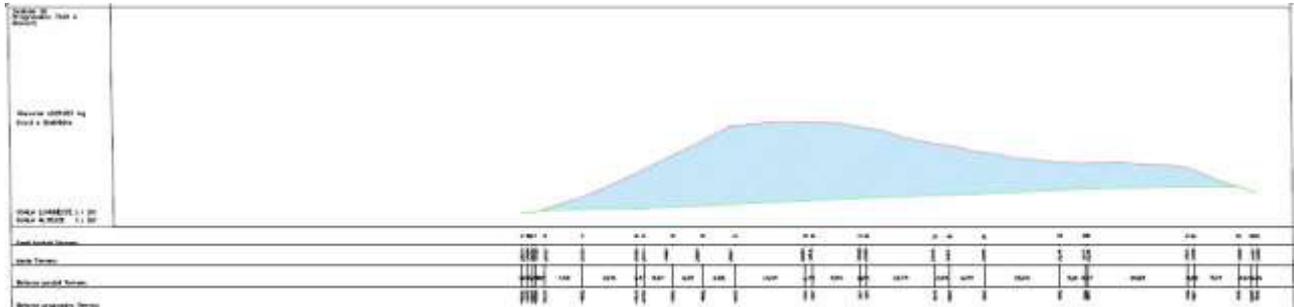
sezione longitudinale del cumulo - estratto dalla relazione tecnica
